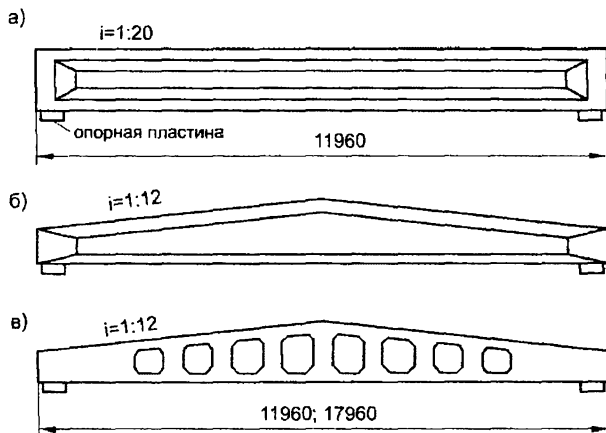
Железобетонные стропильные балки: а – односкатная с горизонтальными поясами; б – двускатная сплошная; в – двускатная решетчатая
